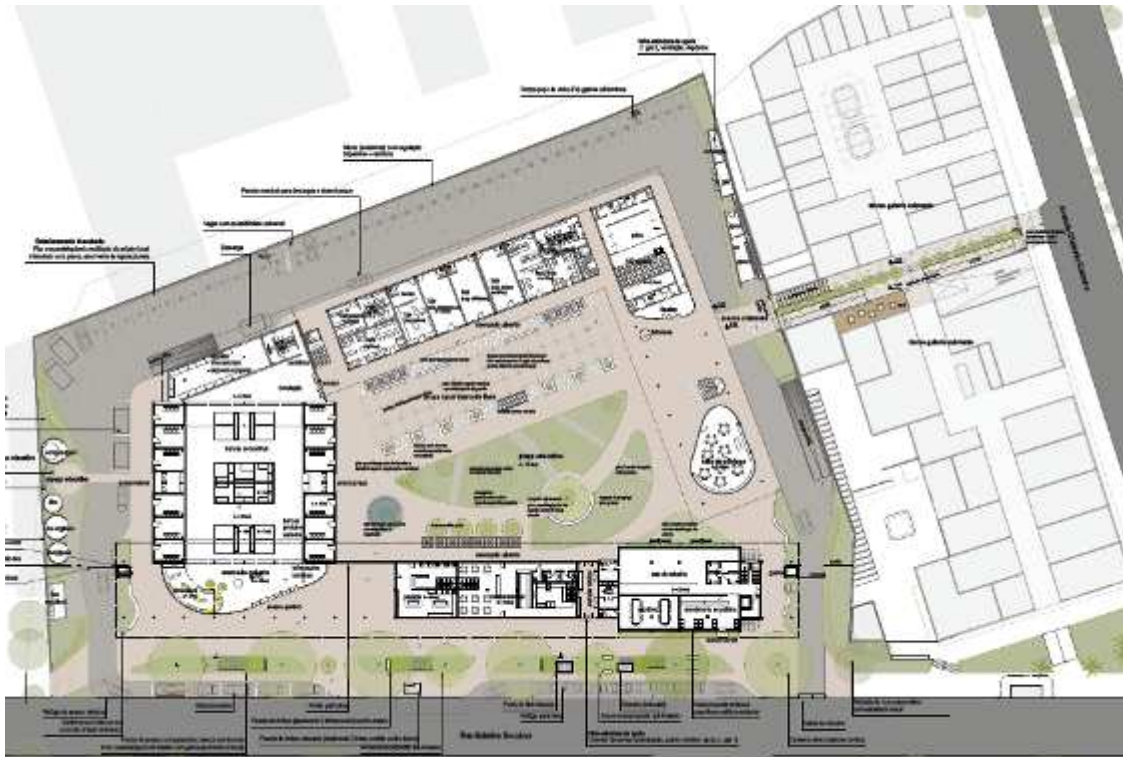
Planta Baixa Térrea do Mercado Público Quintino
